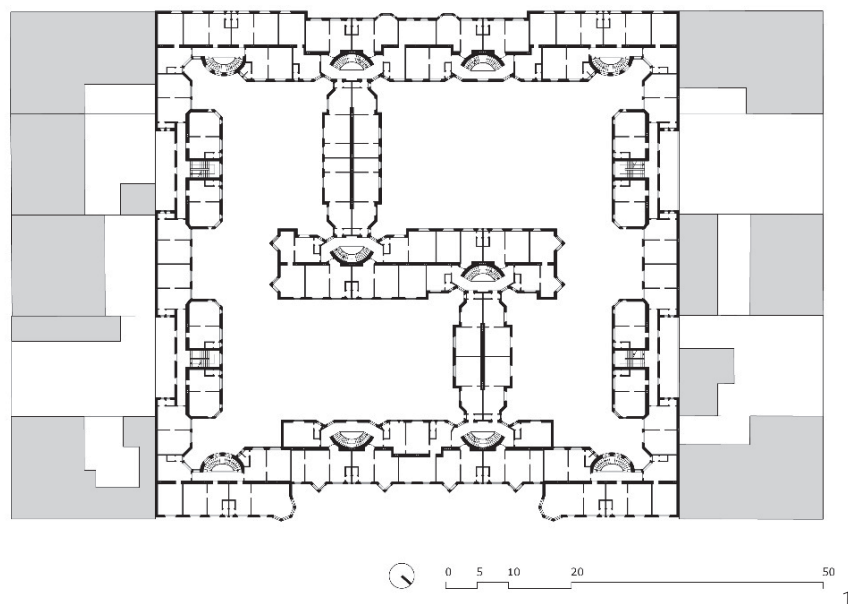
Schüttau-Hof, ridisegno del piano tipo. Alessandro Porotto ©
